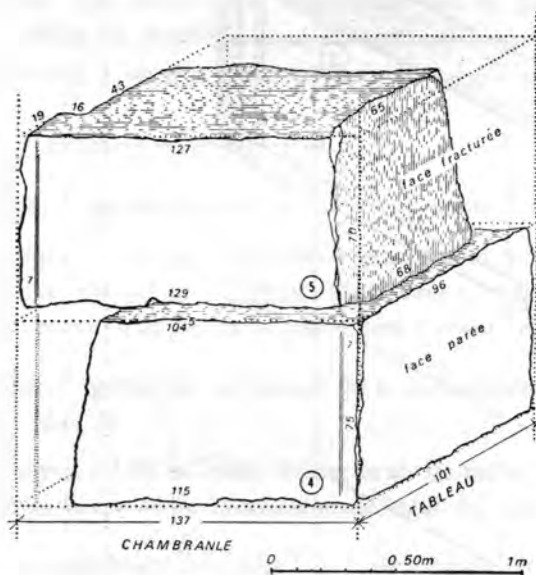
Jambage d'une porte restituée d'après les blocs 4 et 5.
